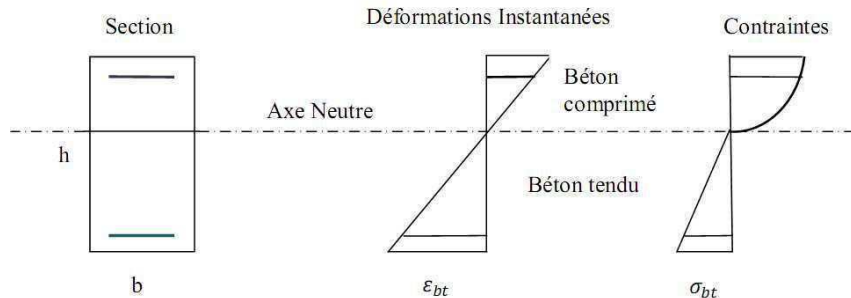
Comportement du béton avant fissuration [66].
